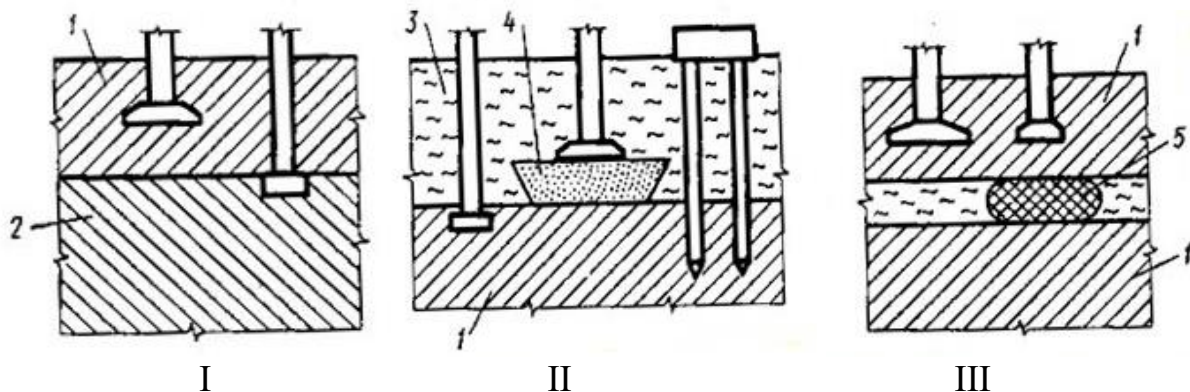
Схеми нашарувань ґрунтів з варіантами влаштування фундаментів:
